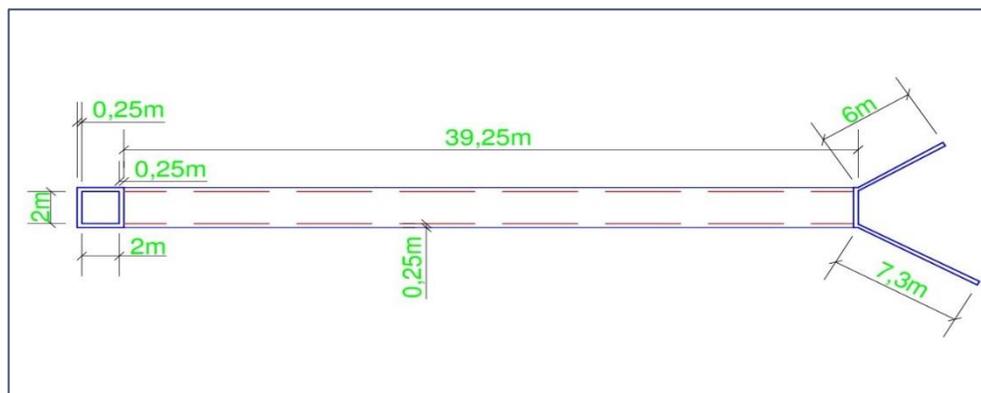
Vista en planta del box coulvert. Fuente propia
